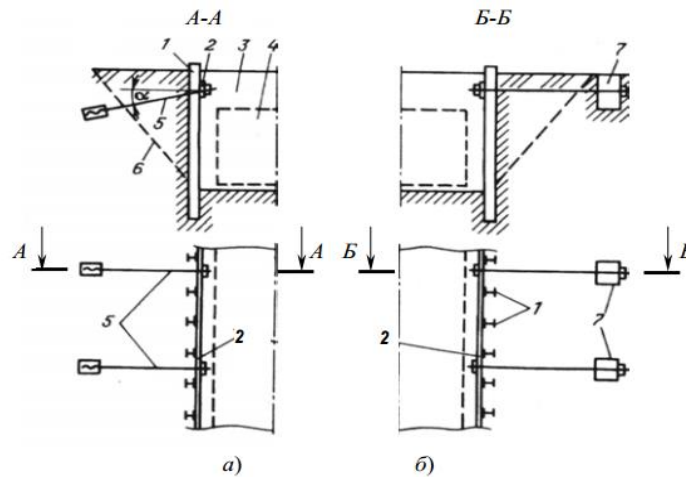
Схемы крепления стен котлованов: 1 – сваи; 2 – пояса; 3 – котлован; 4 – контур подземного сооружения; 5 – анкеры; 6 – призма обрушения; 7 – маячная свая
